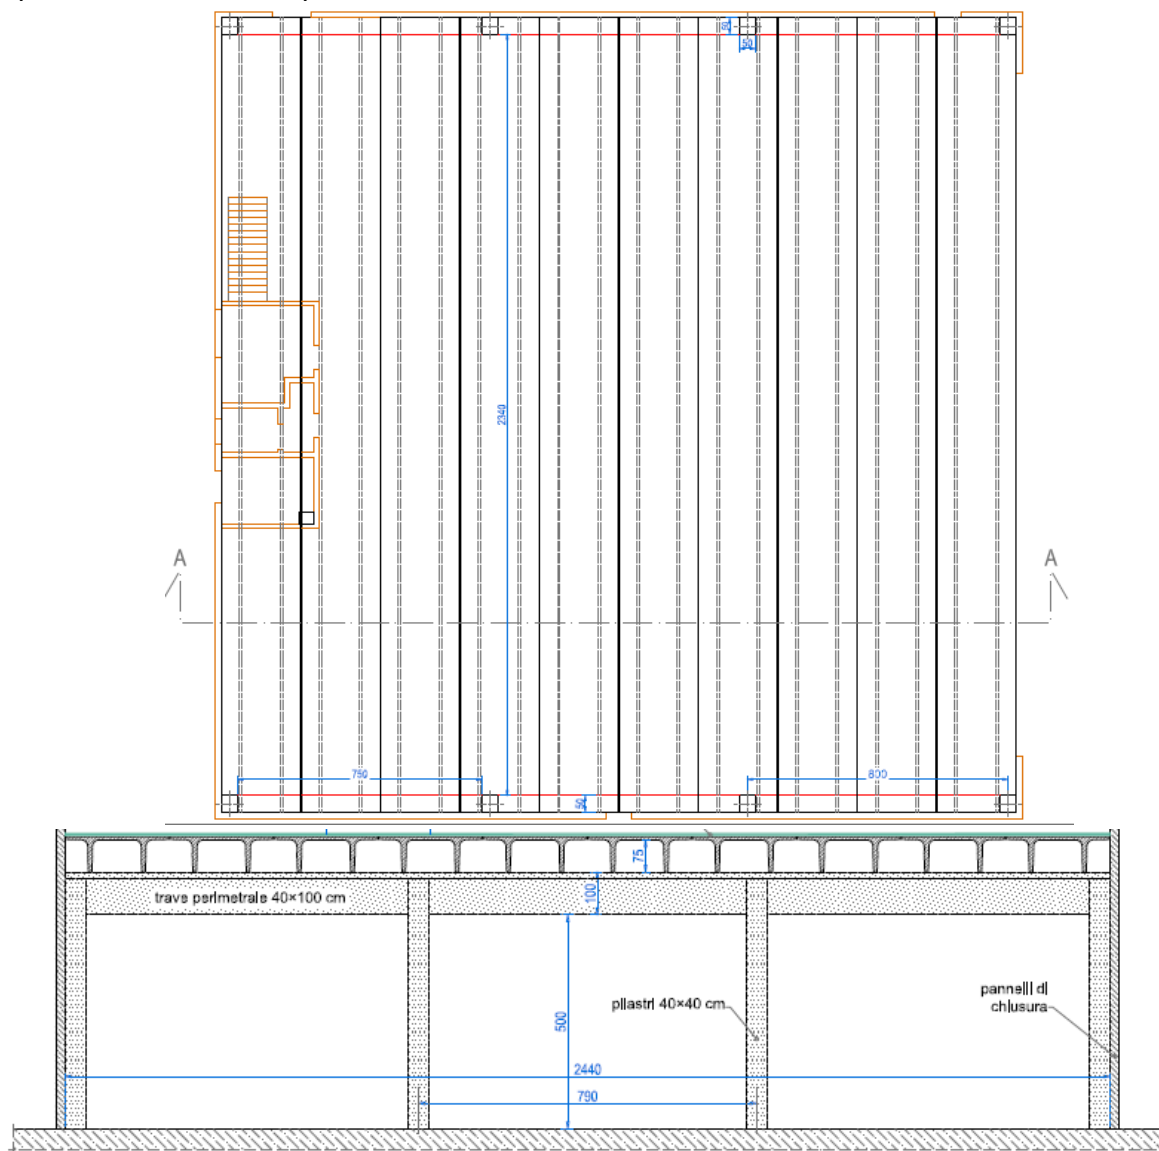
Estratto delle piante e sezioni di rilievo dell'esistente
